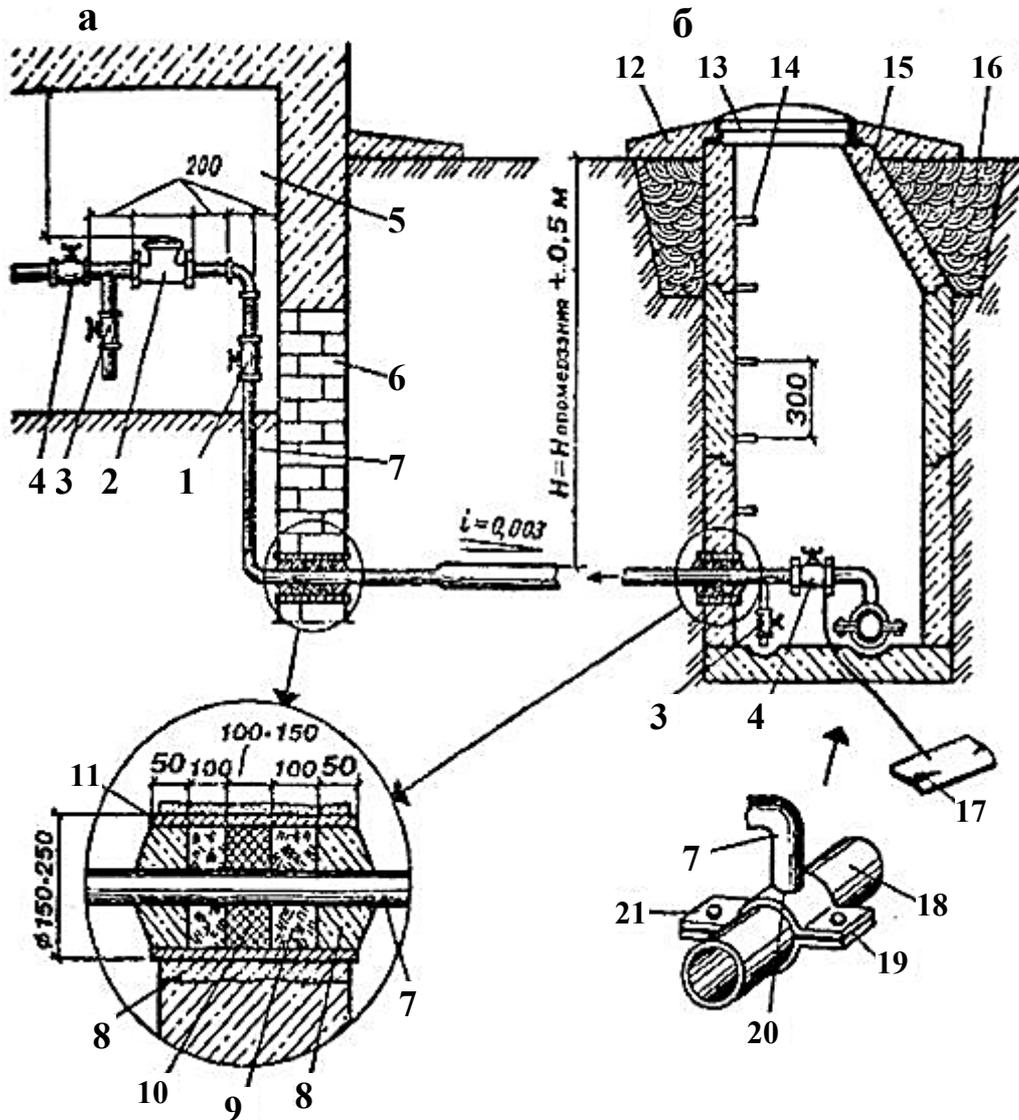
Улаштування водопровідного введення: а – вигляд через фундамент; б – водорозбірний колодязь; 1, 4 – вентилі; 2 – водомір; 3 – зливний кран; 5 – напівпідвал (підвал); 6 – фундамент; 7 – трубопровід уведення; 8 – цементний розчин; 9 – смоляне пасмо (кличчя); 10 – м'ята глина; 11 – футляр; 12 – вимощення; 13 – люк; 14 – ходові скоби; 15 – фасонне бетонне кільце; 16 – глиняний замок; 17 – заземлення; 18 – труба вуличного водопроводу; 19 – гумова прокладка; 20 – зварювання; 21 – хомут
